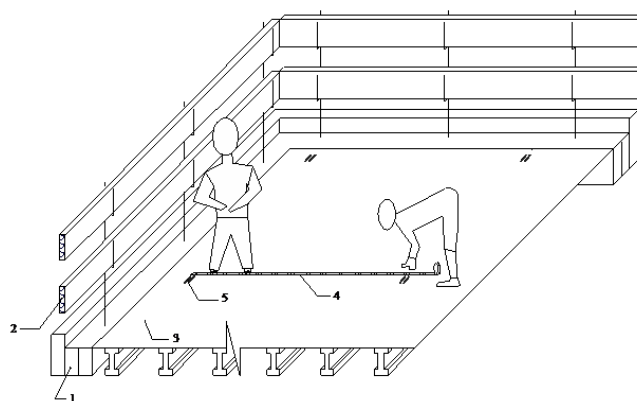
процедура разбивки палубы для монтажа нижней арматурной сетки: 1 – несущая стена; 2 – инвентарное; 3 – палуба опалубки перекрытия; 4 – инструмент - рулетка; 5 – разбивочные оси
